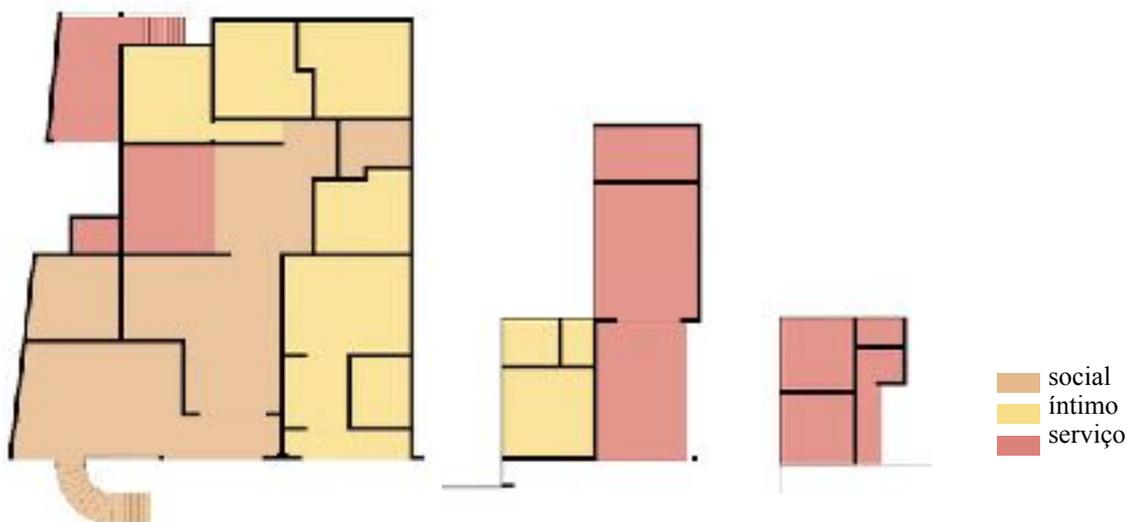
Redesenho e das plantas baixas do pavimento térreo, porão e edícula e zoneamento do projeto. Residência Manoel Araújo.
